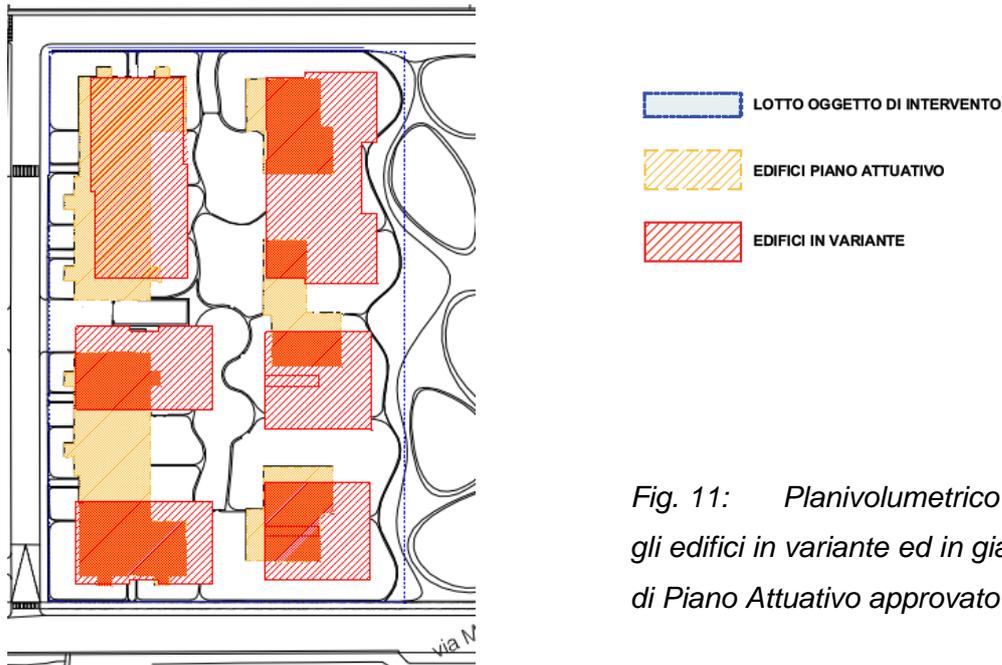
Planivolumetrico – in rosso gli edifici in variante ed in giallo gli edifici di Piano Attuativo approvato
